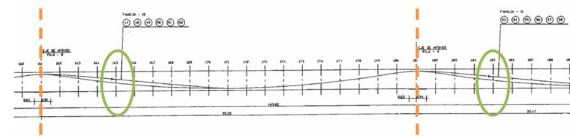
Esquema de alzado de pretensado. En naranja, ejes de pilas y, en verde, zonas de frente de fase/acopladores de pretensado.
